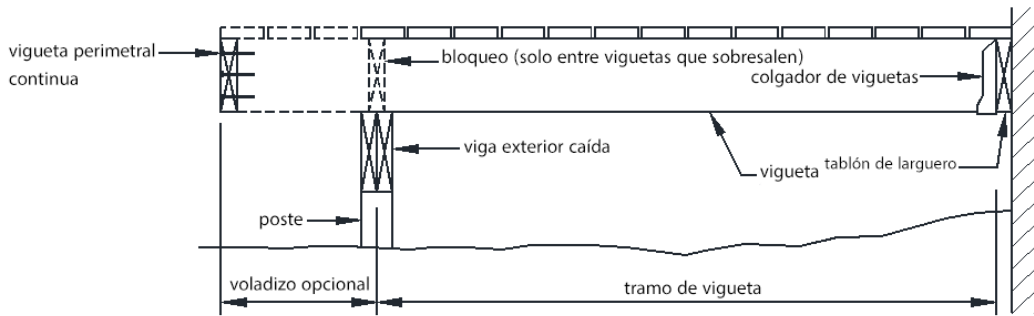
TERRAZA SENCILLA - VIGUETAS UNIDAS A LA CASA CON VIGA CAÍDA
